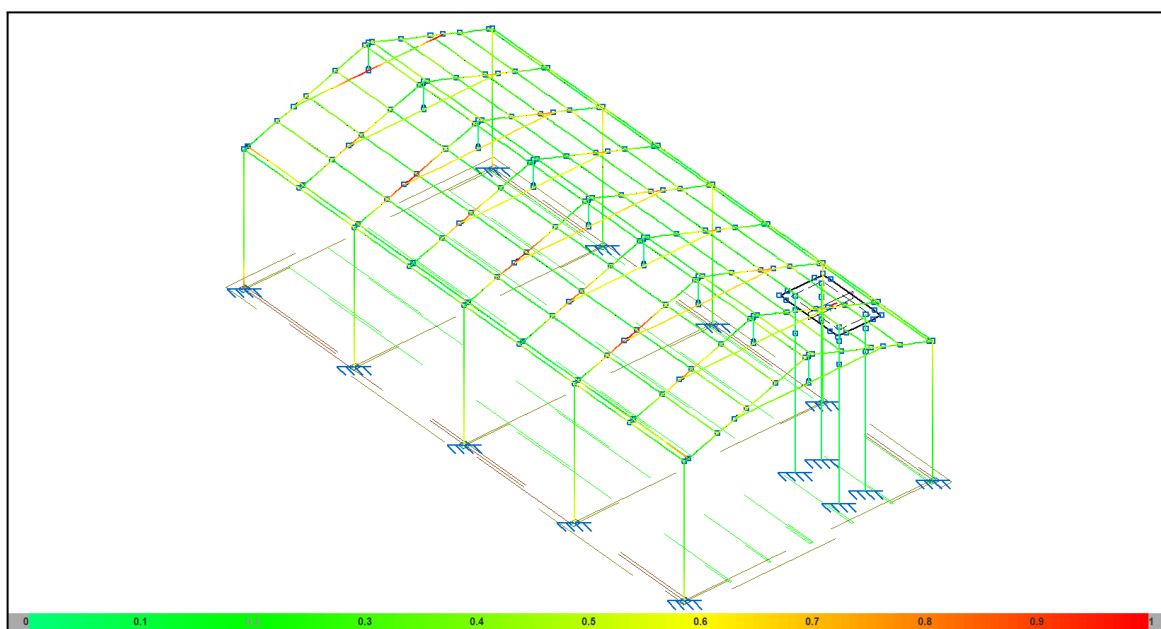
Ratios de uso para secciones metálicas y refuerzos de muro para apoyo de tanque ($Esf/Res < 1$).
